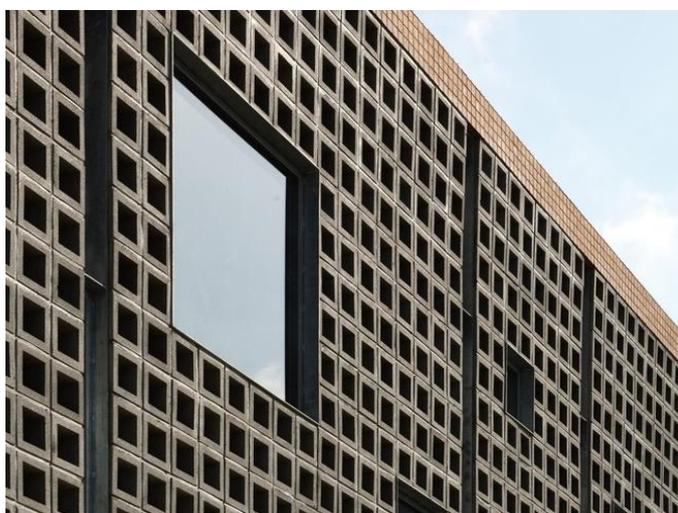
Tijolos de concreto vazados na fachada da edificação.
